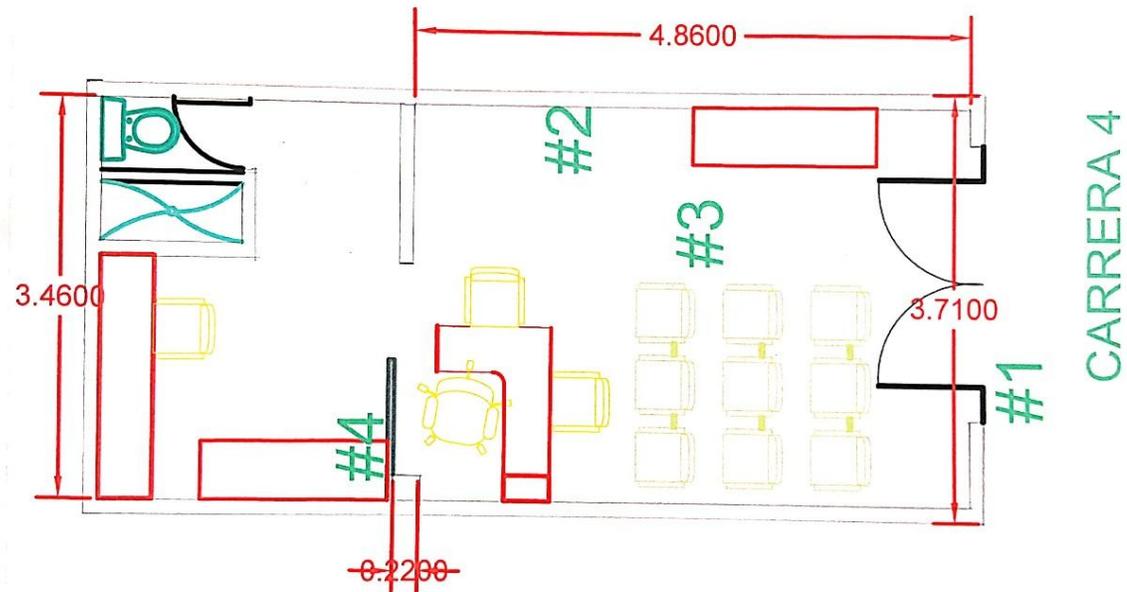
Plano arquitectónico sede CIS Cimitarra.
